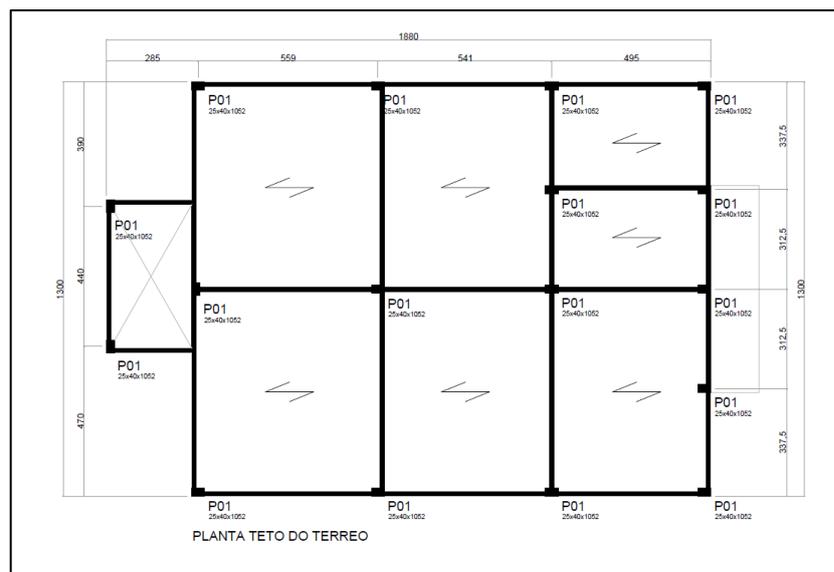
Projeto estrutural 02: Nível +3,90 m
